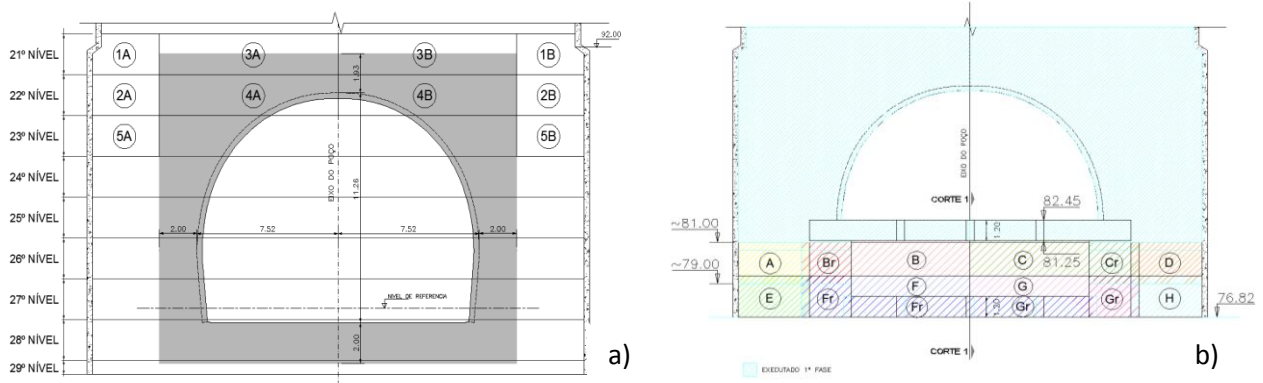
a) 1ª fase de reforço na zona do emboquilhamento do túnel de ventilação; b) 2ª fase de reforço na zona do emboquilhamento do túnel de ventilação. (adaptado NE ACE, 2010).
